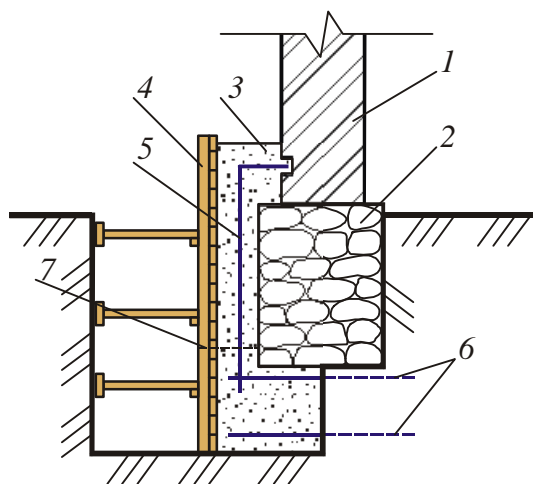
Углубление подошвы фундамента без разгрузки:
